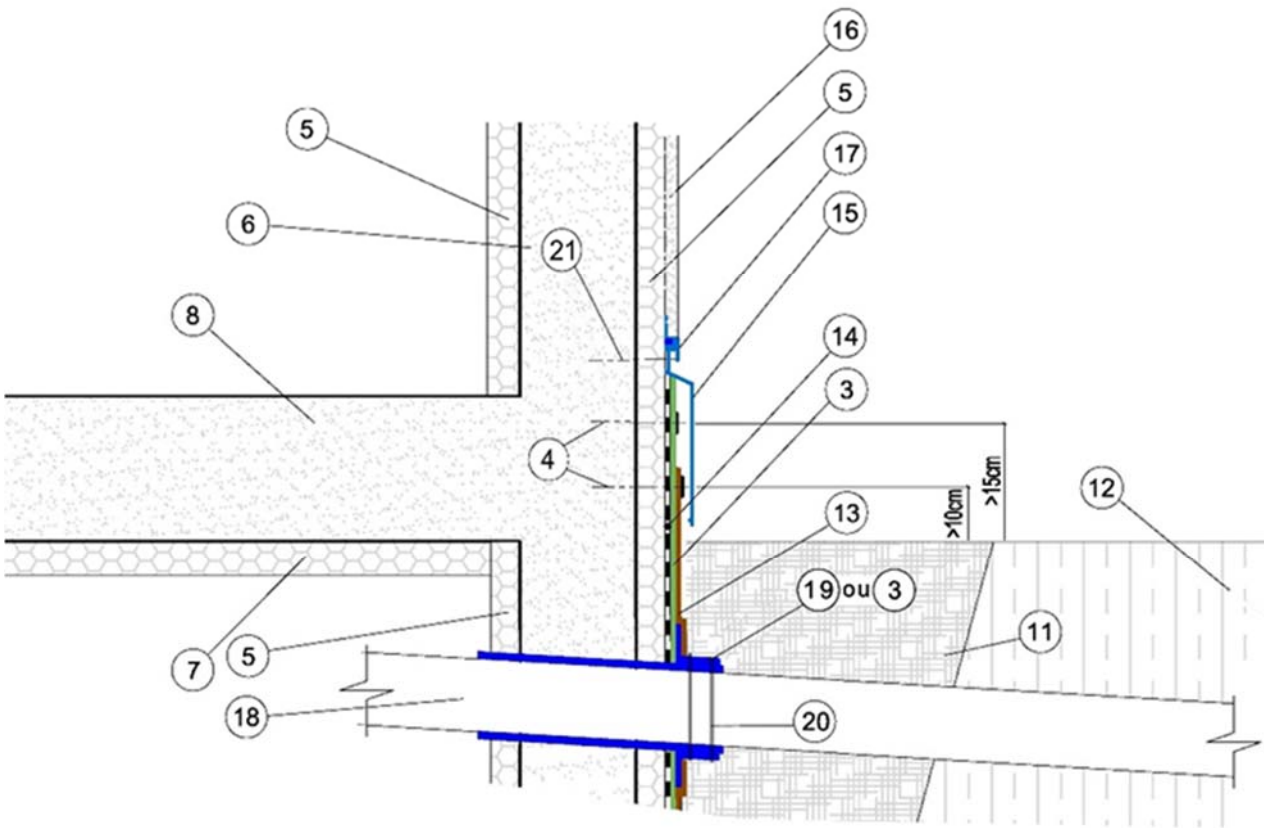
Traitement des traversées horizontales sur mur extérieur enterré
